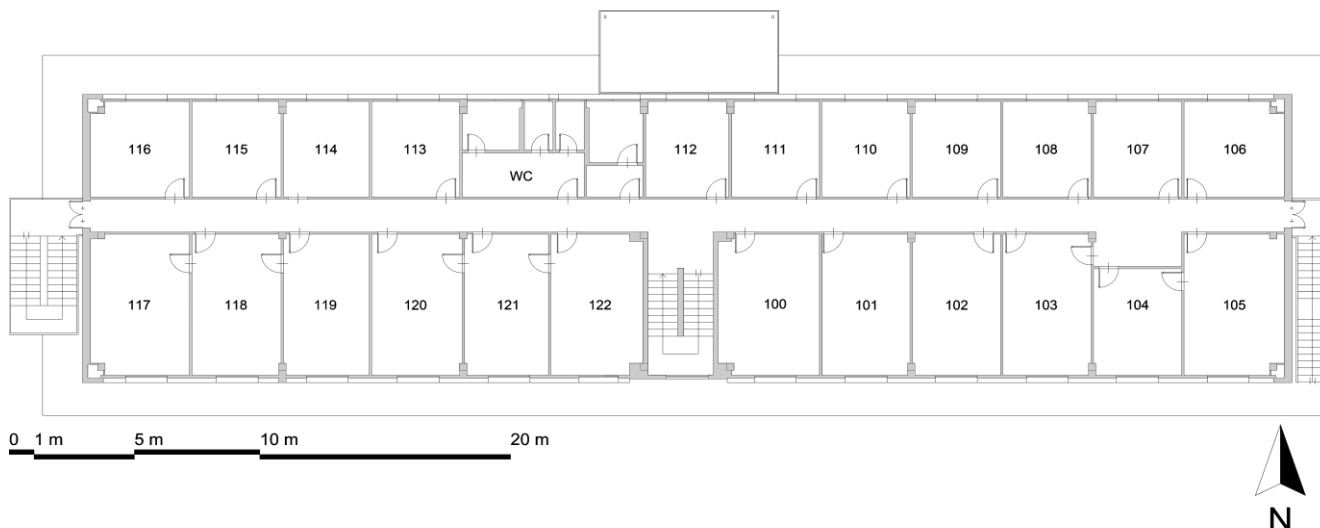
Planimetria dell’edificio F51 del Centro Ricerche Casaccia dell’ENEA.
